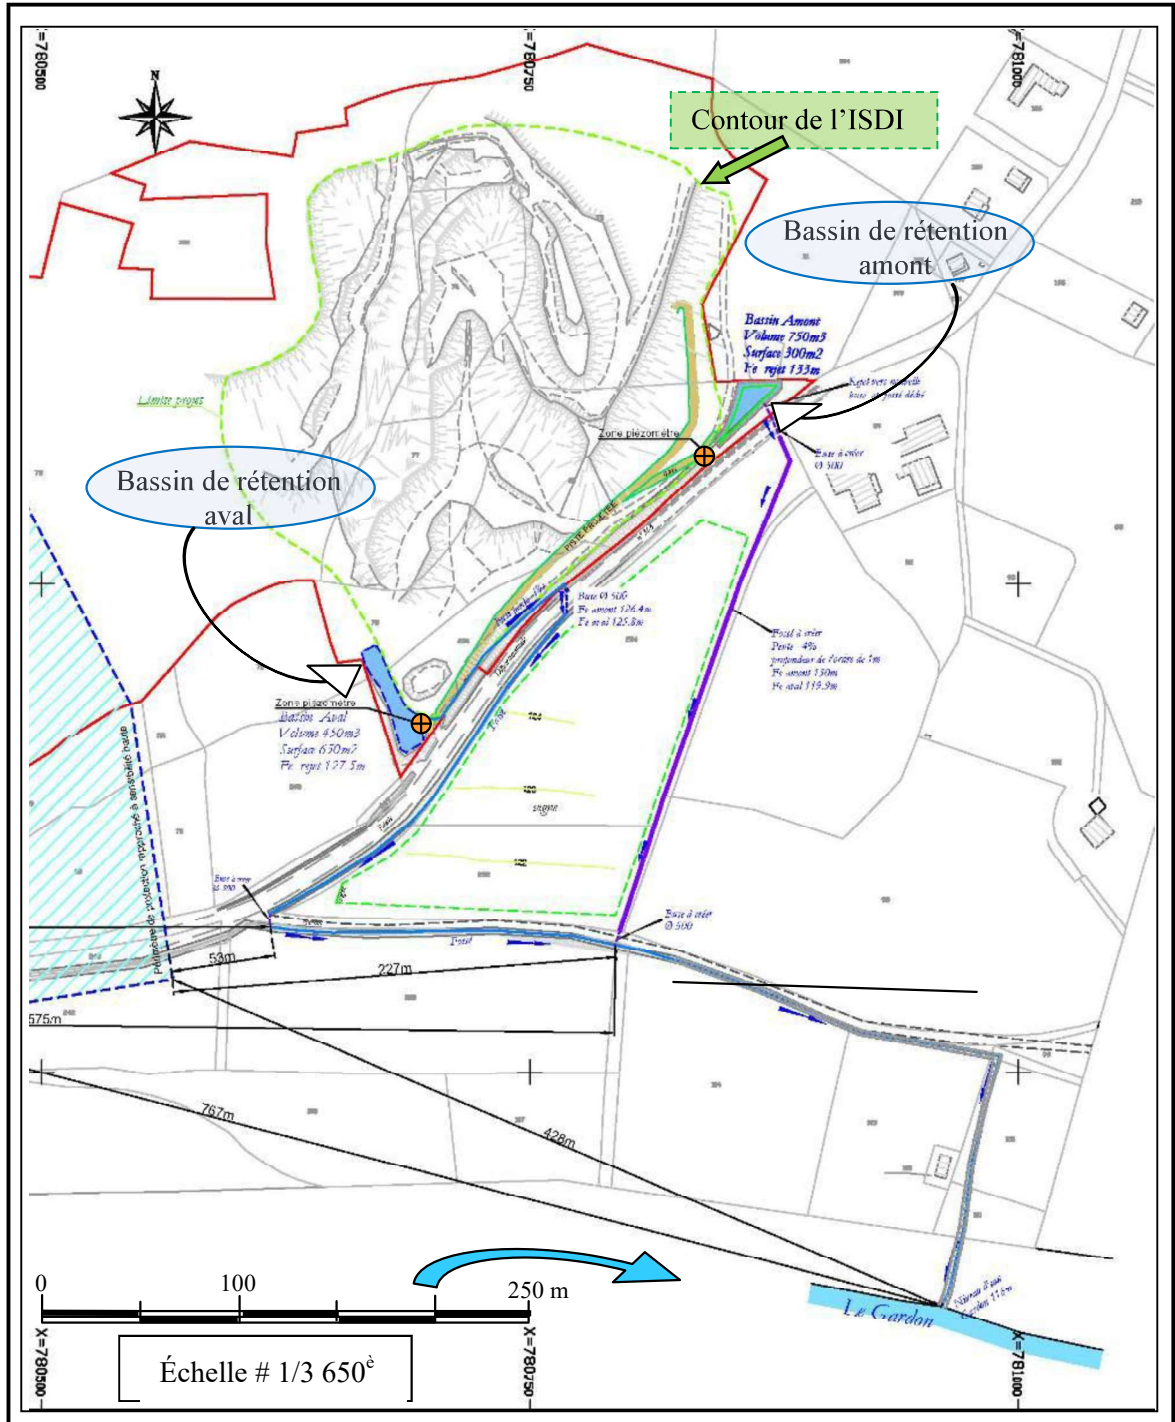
PLAN DE MASSE DES OUVRAGES HYDRAULIQUES PROJETÉS
